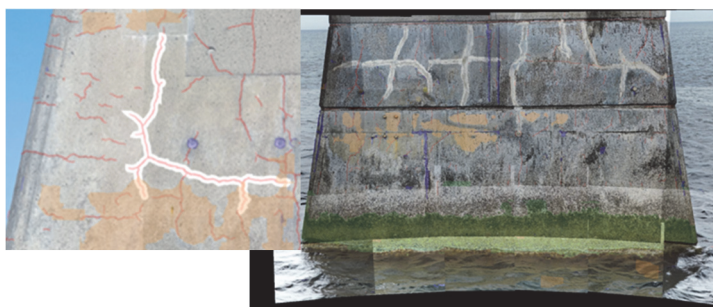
ひび割れ検出と撮影画像繫結合イメージ
